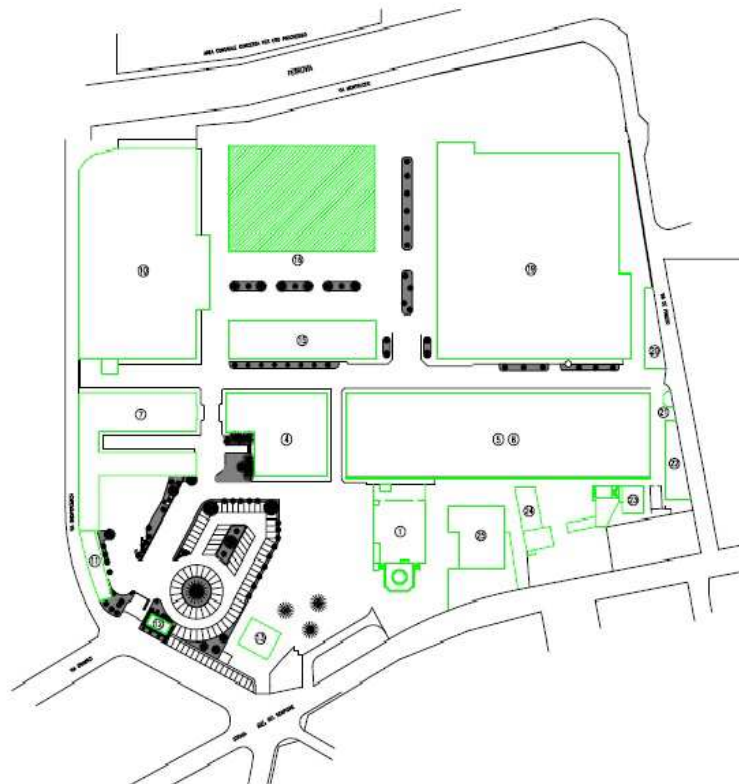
Planimetria generale stabilimento AgustaWestland di Sesto Calende.
